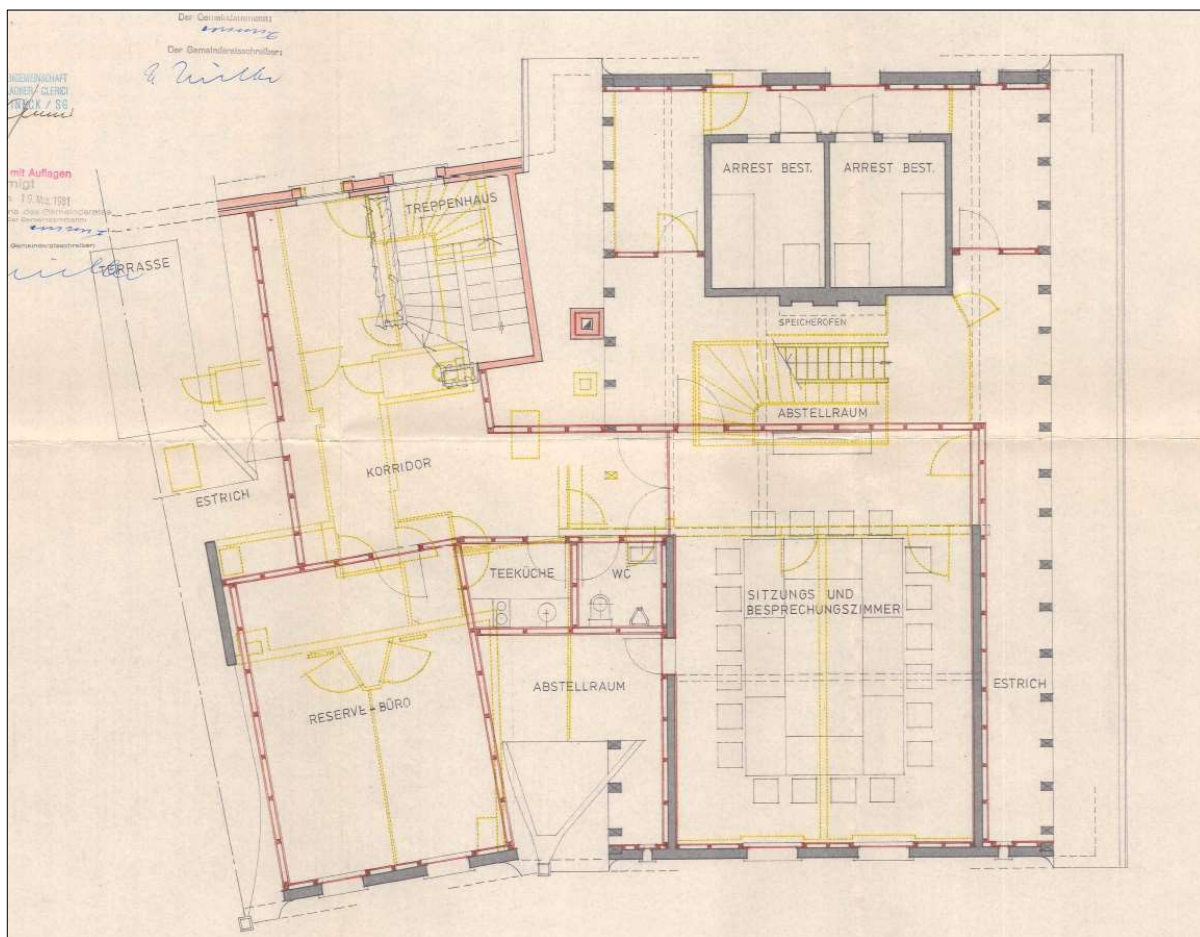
Grundriss 1. Dachgeschoss. Projektplan von 1981.¹⁷ Diese Planung wurde mit kleinen Abweichungen umgesetzt. Um die Grundrissveränderungen im 2. Obergeschoss zu ermöglichen, wurde die Dachkonstruktion in der nördlichen Raumschicht durch den Einzug von einfachen Sprengwerken unter den Mittelpfetten verstärkt und die beiden Arrestzellen an dieser Konstruktion aufgehängt. Über dem Sitzungs- und Besprechungsraum entstand die Dachkonstruktion vollständig neu.
